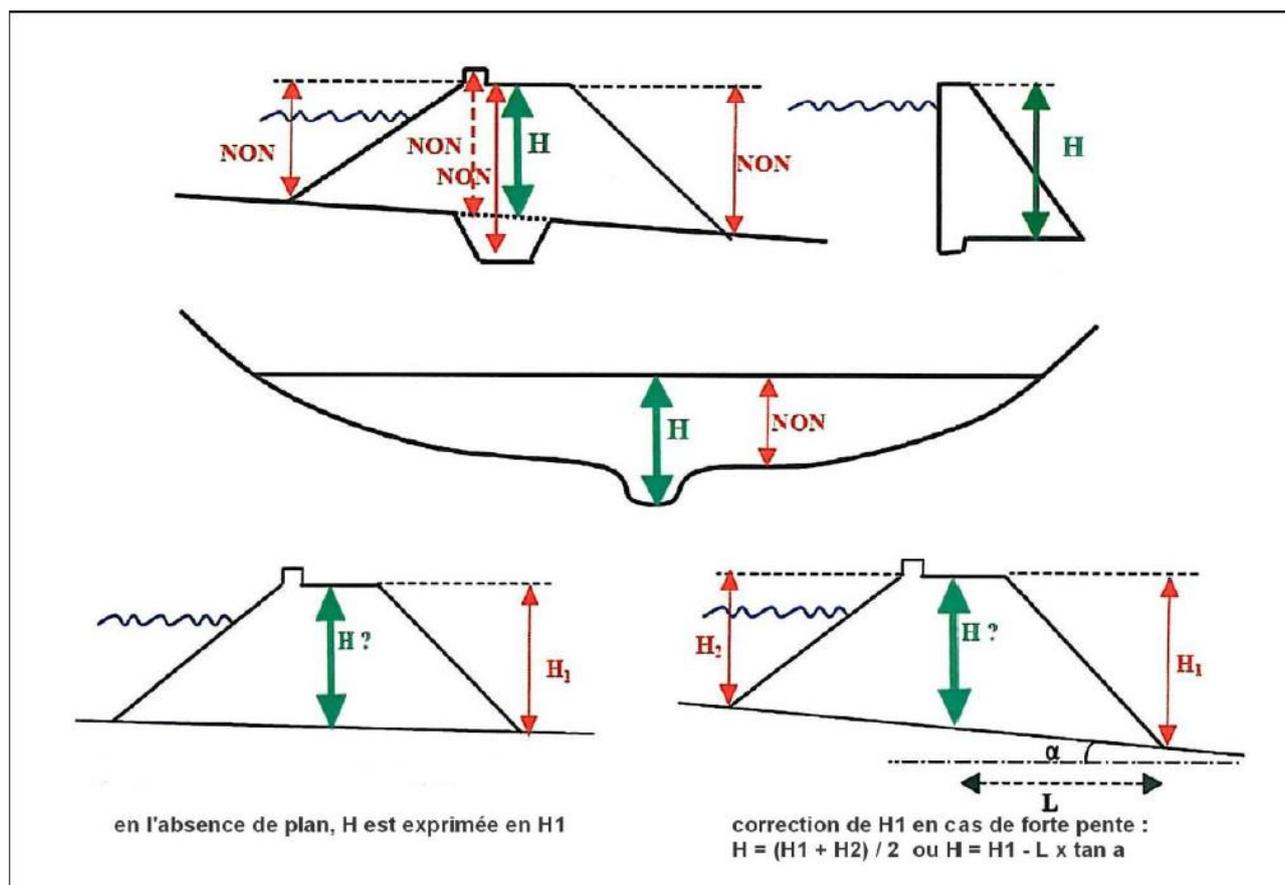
Coupes schématique d'un barrage en terre ou d'un barrage poids
